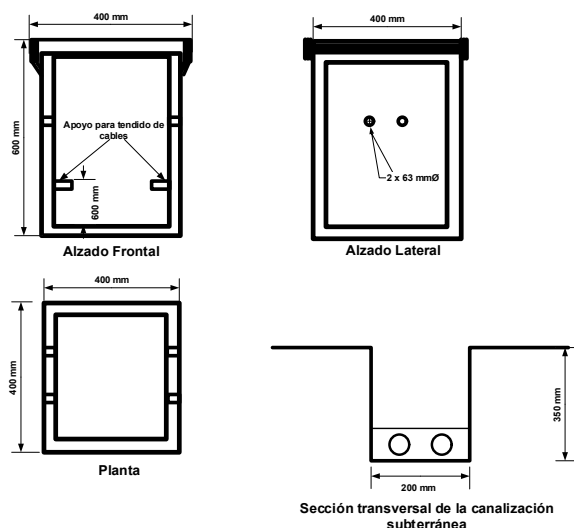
Alzados y planta de las arquetas de 400 x 400 x 600mm.
